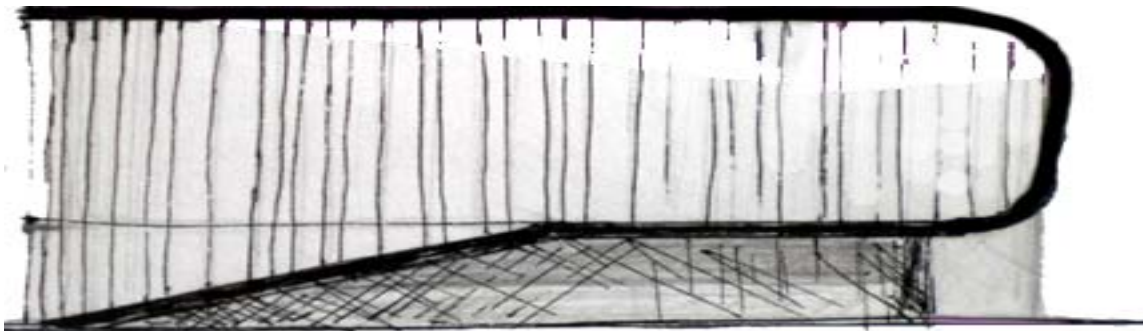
Segundo boceto de propuesta para fachada principal (este).
